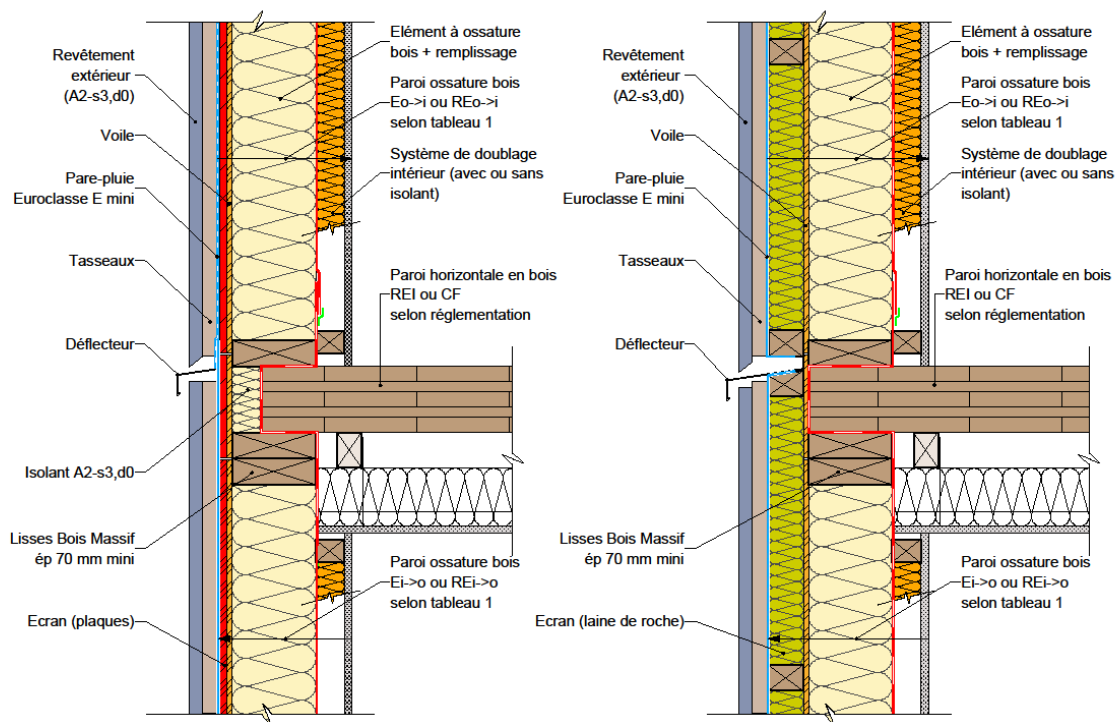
Façade/mur en ossature bois & plancher en panneaux bois massif.
